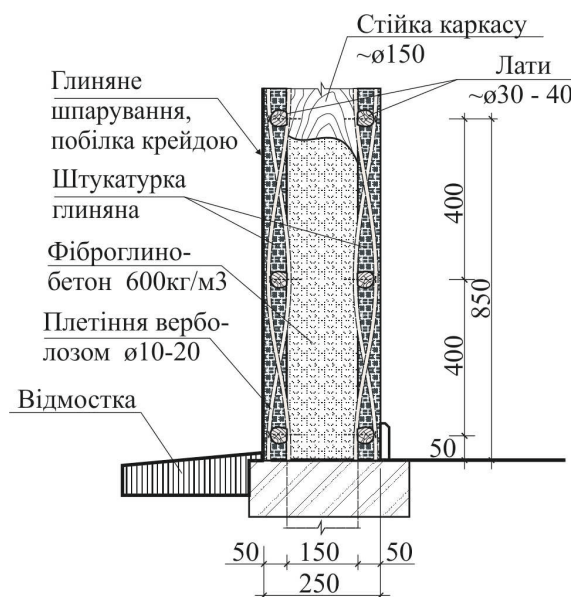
Конструкція стіни господарської будівлі з фіброглинобетону
